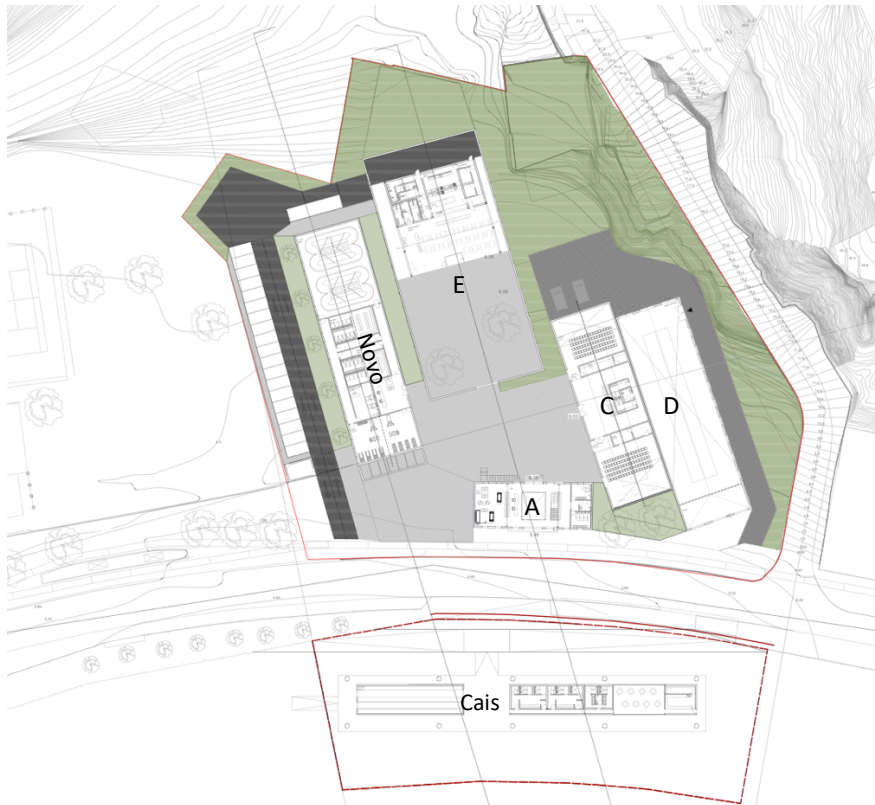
Planta piso 0 – 5ª proposta (fonte: autora)
